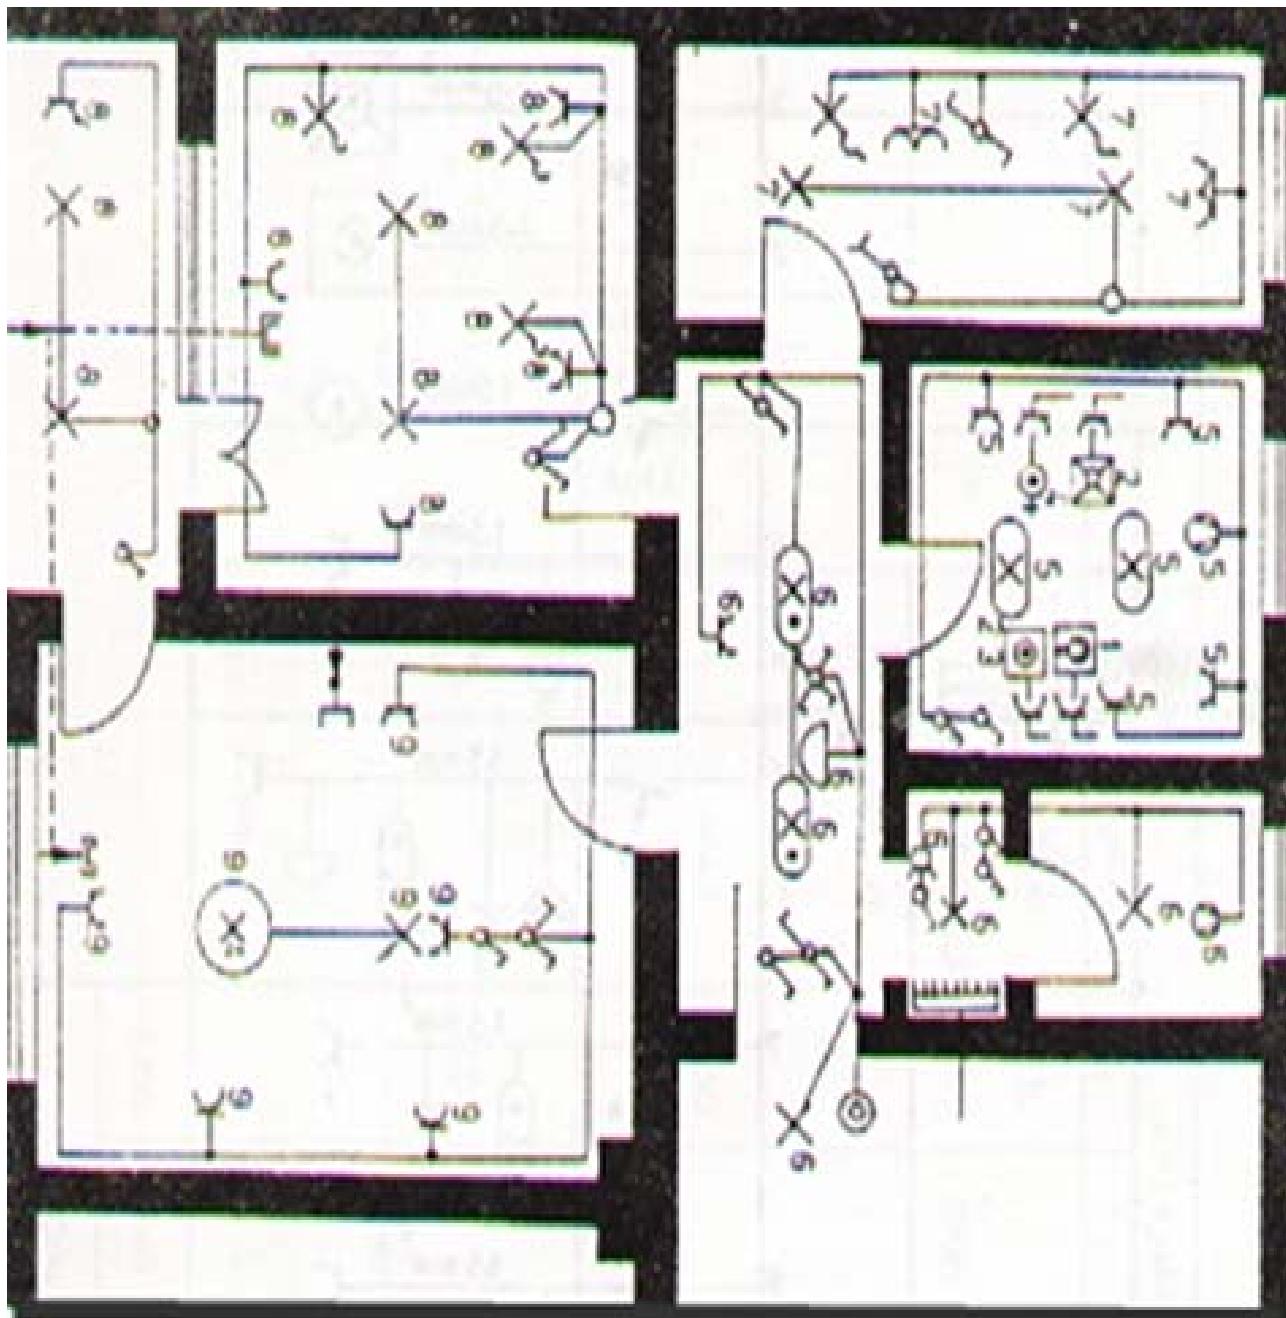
٢) مسقط أفقي للشقة لتحديد الأحمال الكهربائية اللازمة
